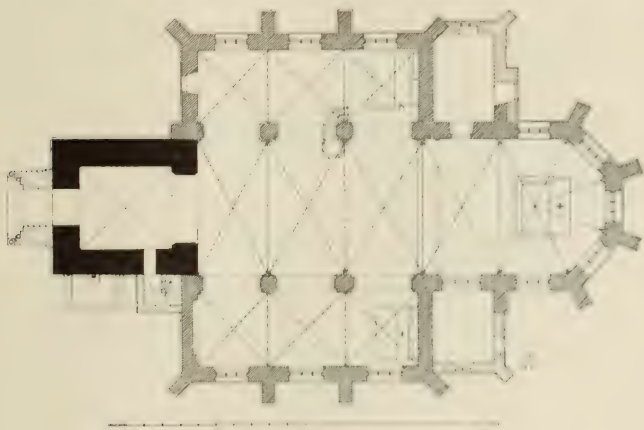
Paffendorf. Grundriss der katholischen Pfarrkirche
